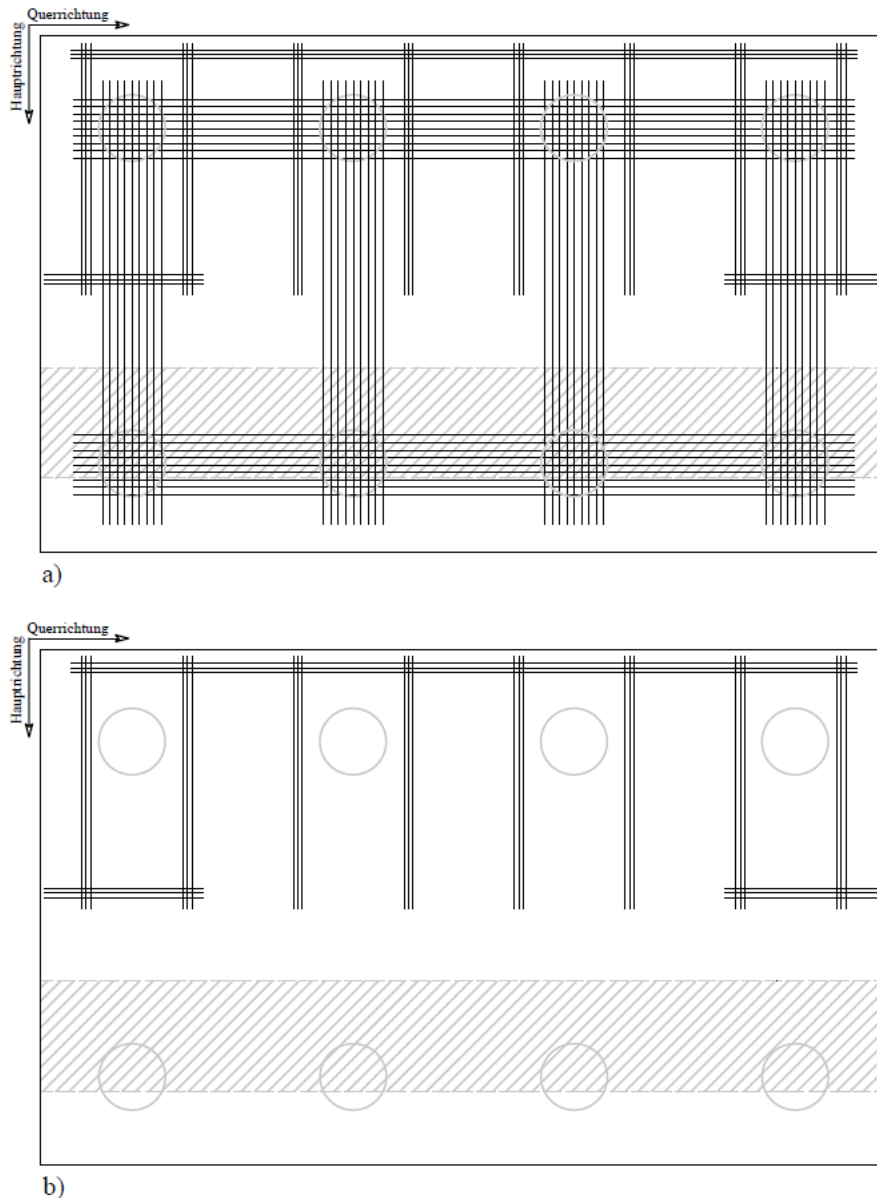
Variante 2 Lastfall 1 - a)Bewehrung unten, b)Bewehrung oben
